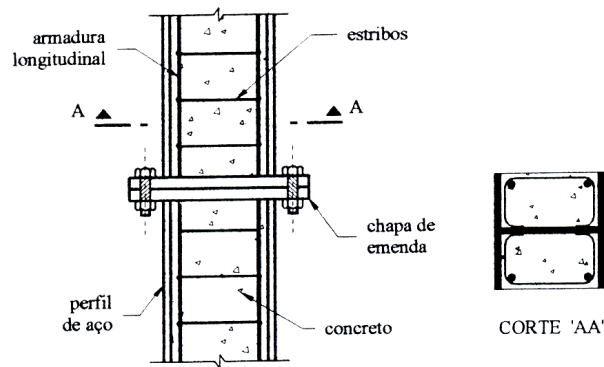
Emenda de pilares para uma seção metálica parcialmente envolvida com concreto (Chaves, 2001).
